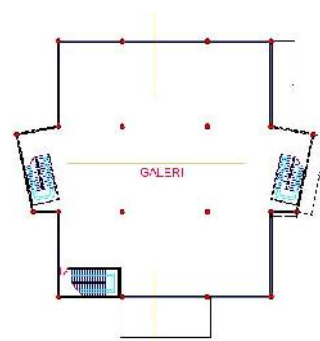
Denah Lantai 1 Bangunan Pameran
